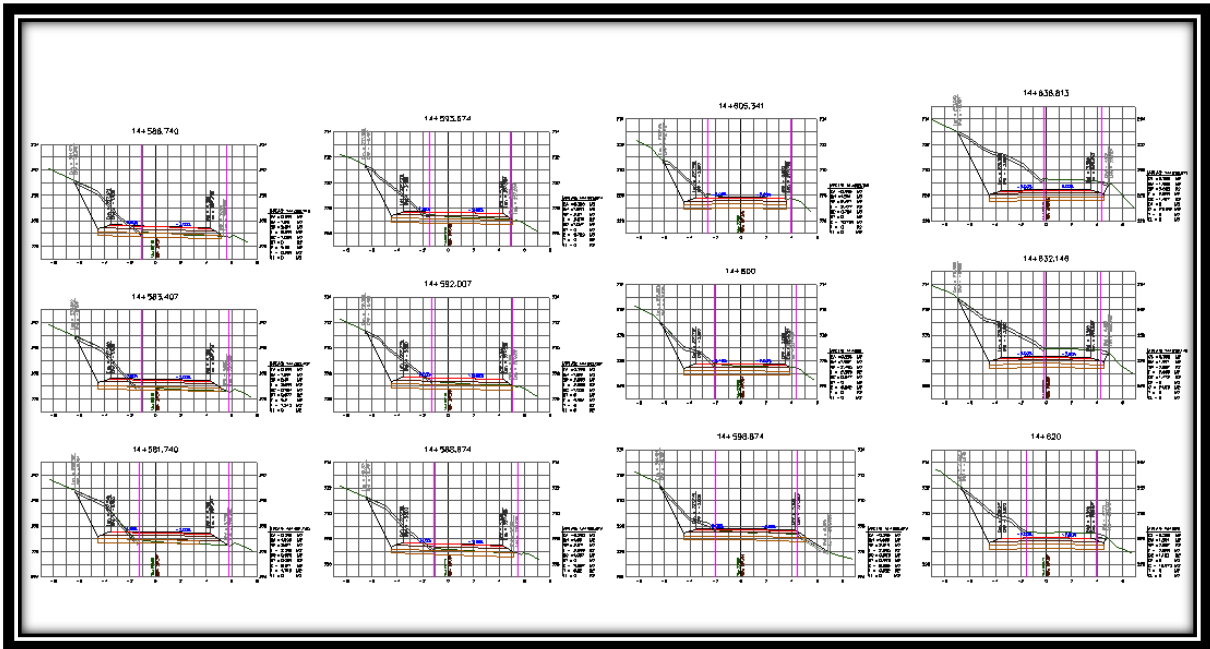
Secciones de construcción del km 14+581.740 al km 14+613.813.
